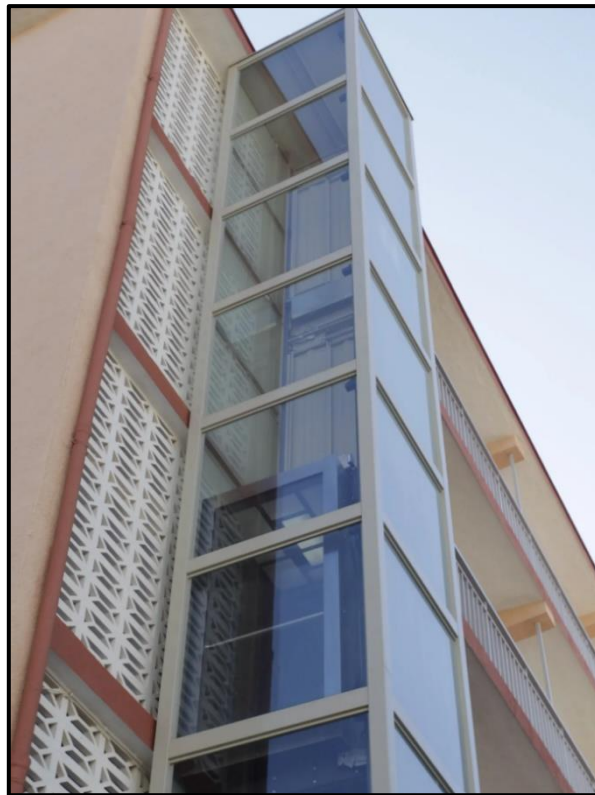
Modelo Instalación Ascensor Panorámico en Fachada Edificios Existentes.
